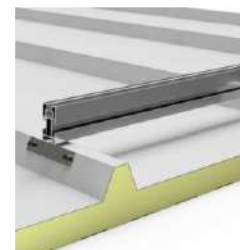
Suporte com fixação lateral, para perfil corrido, cobertura metálica.
